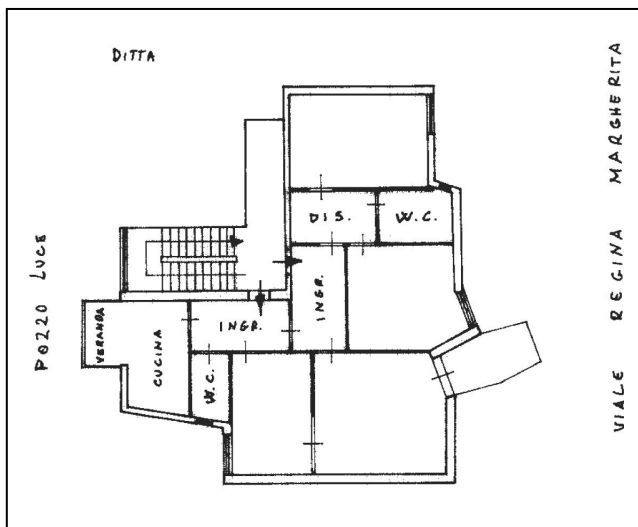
Estratto planimetria catastale del 14/05/1986
